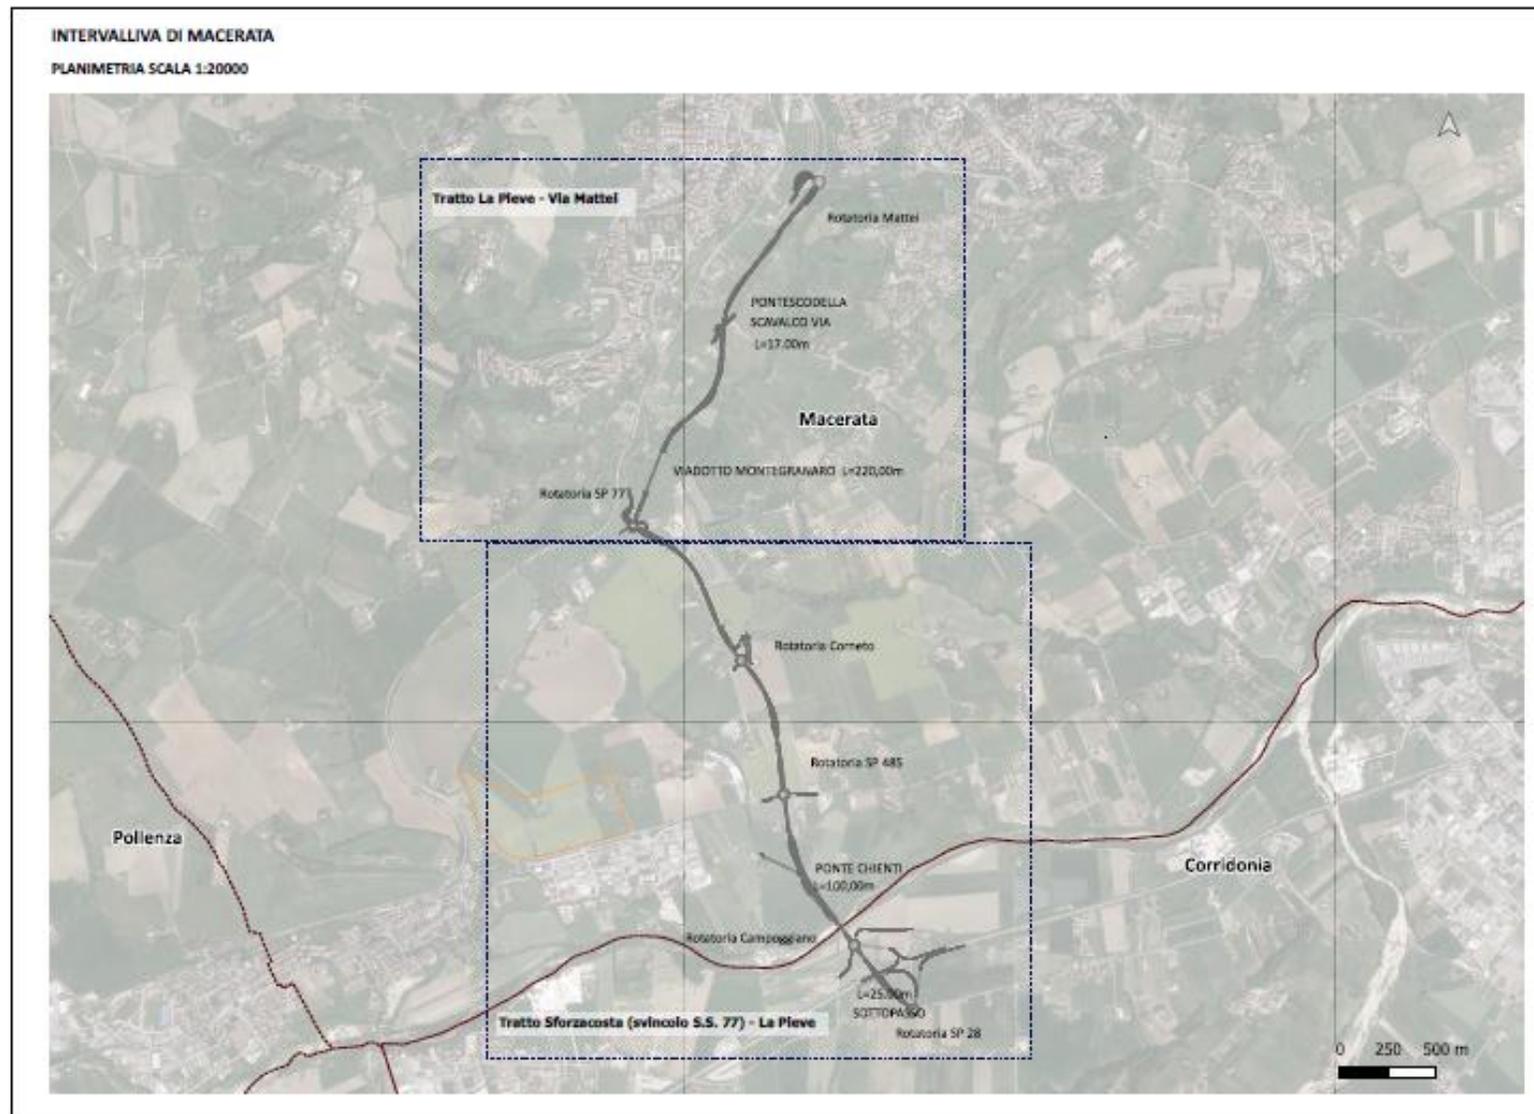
Planimetria dell'area con indicazione della porzione in progetto (tratto la pieve – via Mattei)
